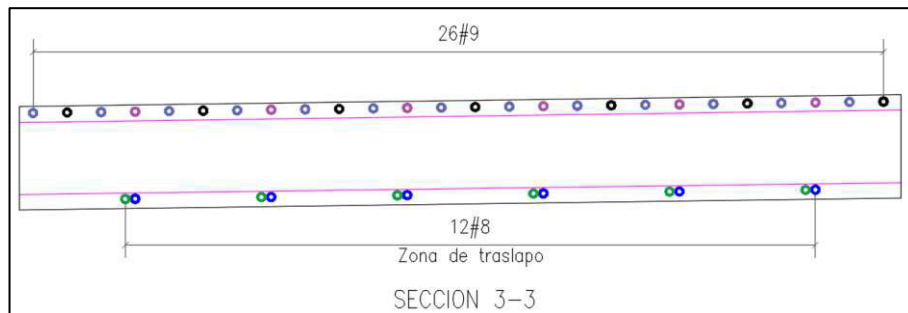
Refuerzo suministrado corte 3-3 – FIN
